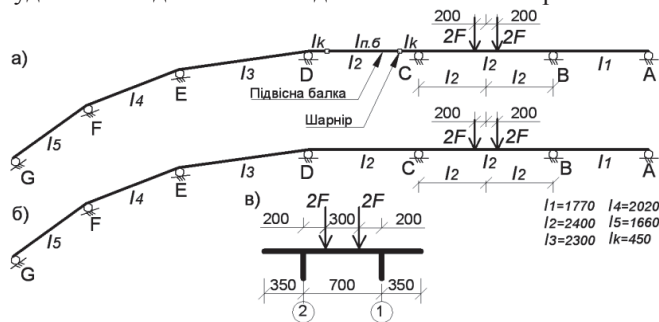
Схеми навантаження дослідних конструкцій при випробуваннях:
